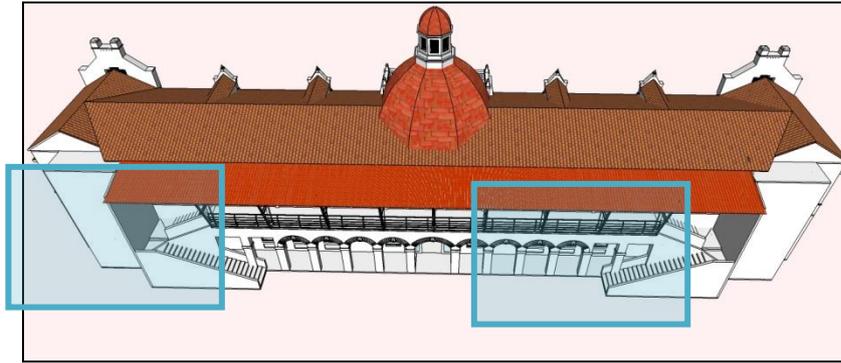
Jendela depan lantai 1 dan 2 'Hallo Surabaya'
